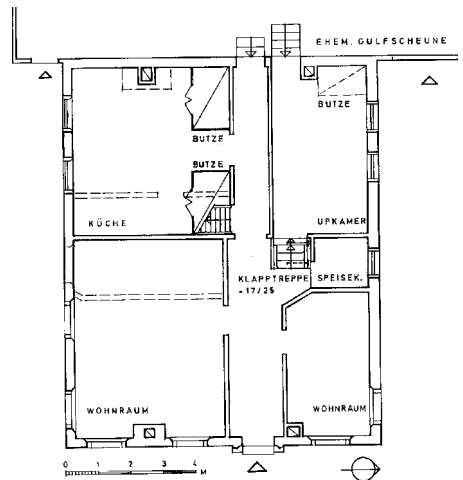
Jemgum, Sielstraße 13, Grundriß
